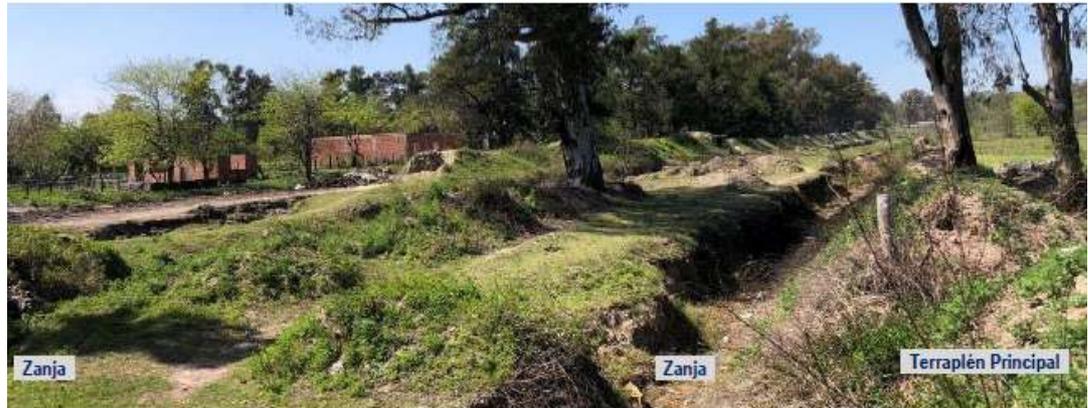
Terraplenes y Zanjonas en intersección con Salgari - Vista hacia el Sur.
